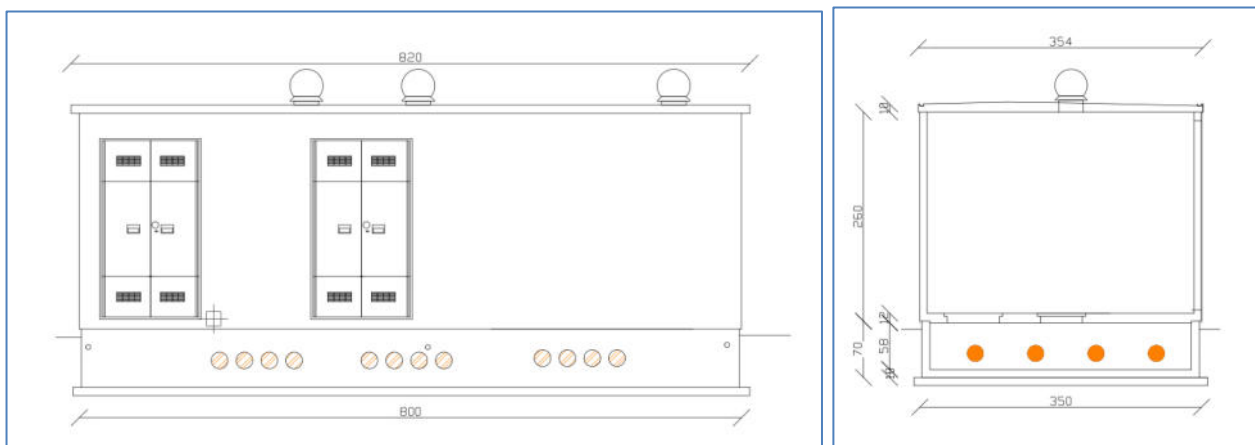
Prospetto lato campo e sezione tipo del locale monitoraggio con posizionamento su vasca di fondazione.
